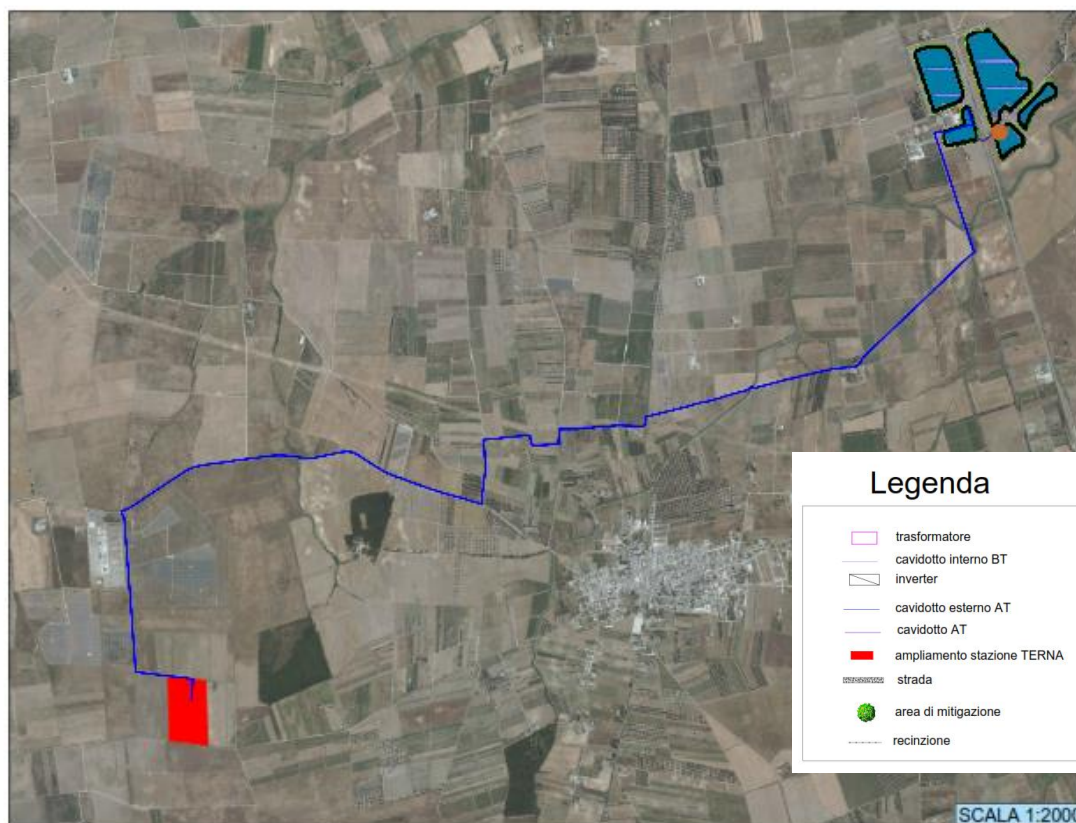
Planimetria generale dell'impianto su ortofoto.
